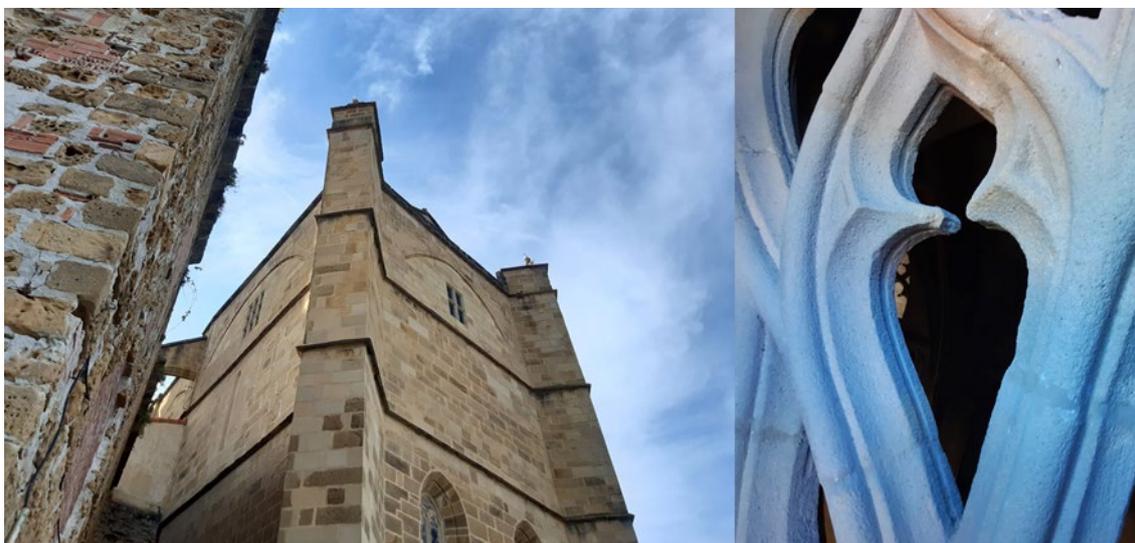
Alzado este de San Salvador y hendiduras en tracerías del claristorio. Fuente: Mujika, M (2021)
